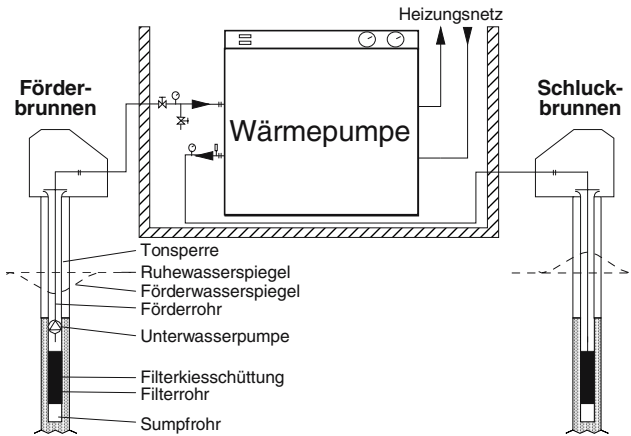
Prinzipschema einer Grundwasser-Wärmepumpenanlage (nach /8-24/)
